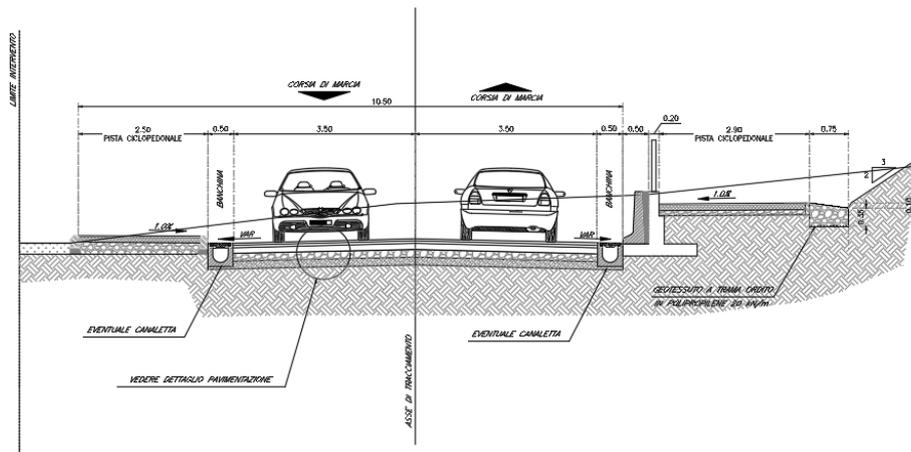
Sezione tipo in trincea con muro di sostegno.
